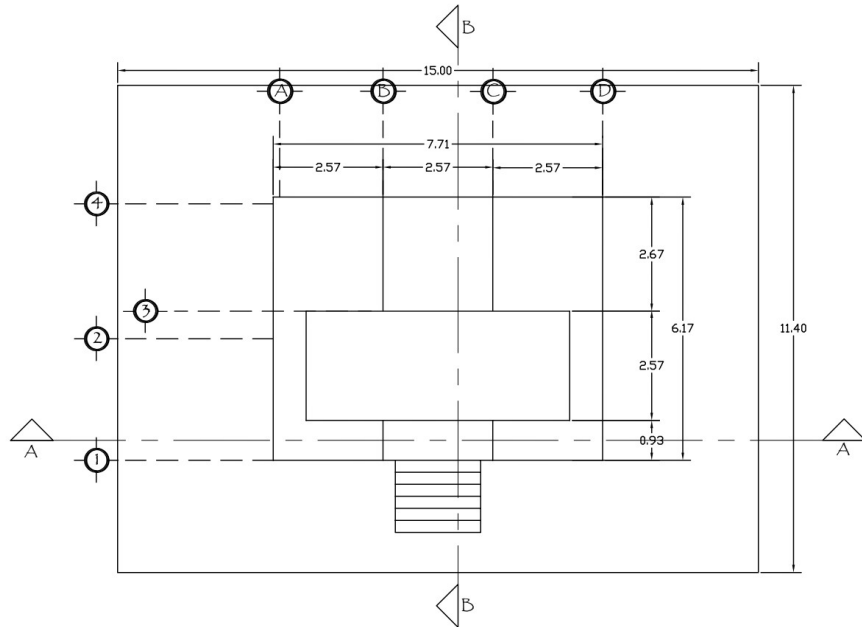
Planta Cubierta Tipología - A - Elaboración propia
